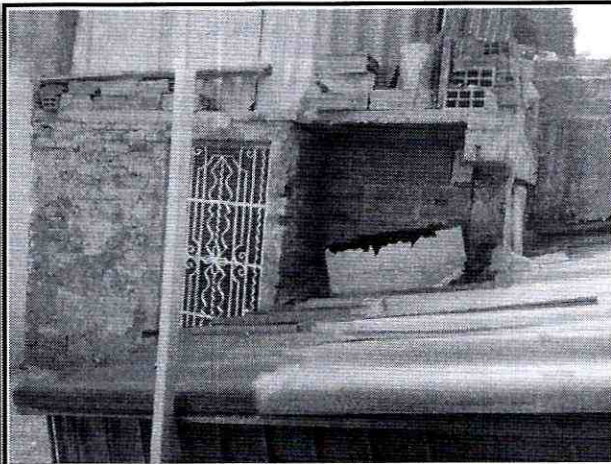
Grietas y fisuras en predio de la Calle 25B Bis No. 3A – 27/29 localizadas en muro occidental que lindera con Carrera 3A. En la zona delimitada se observa grieta de 0.3 cm y desnivel en el marco de la ventana
